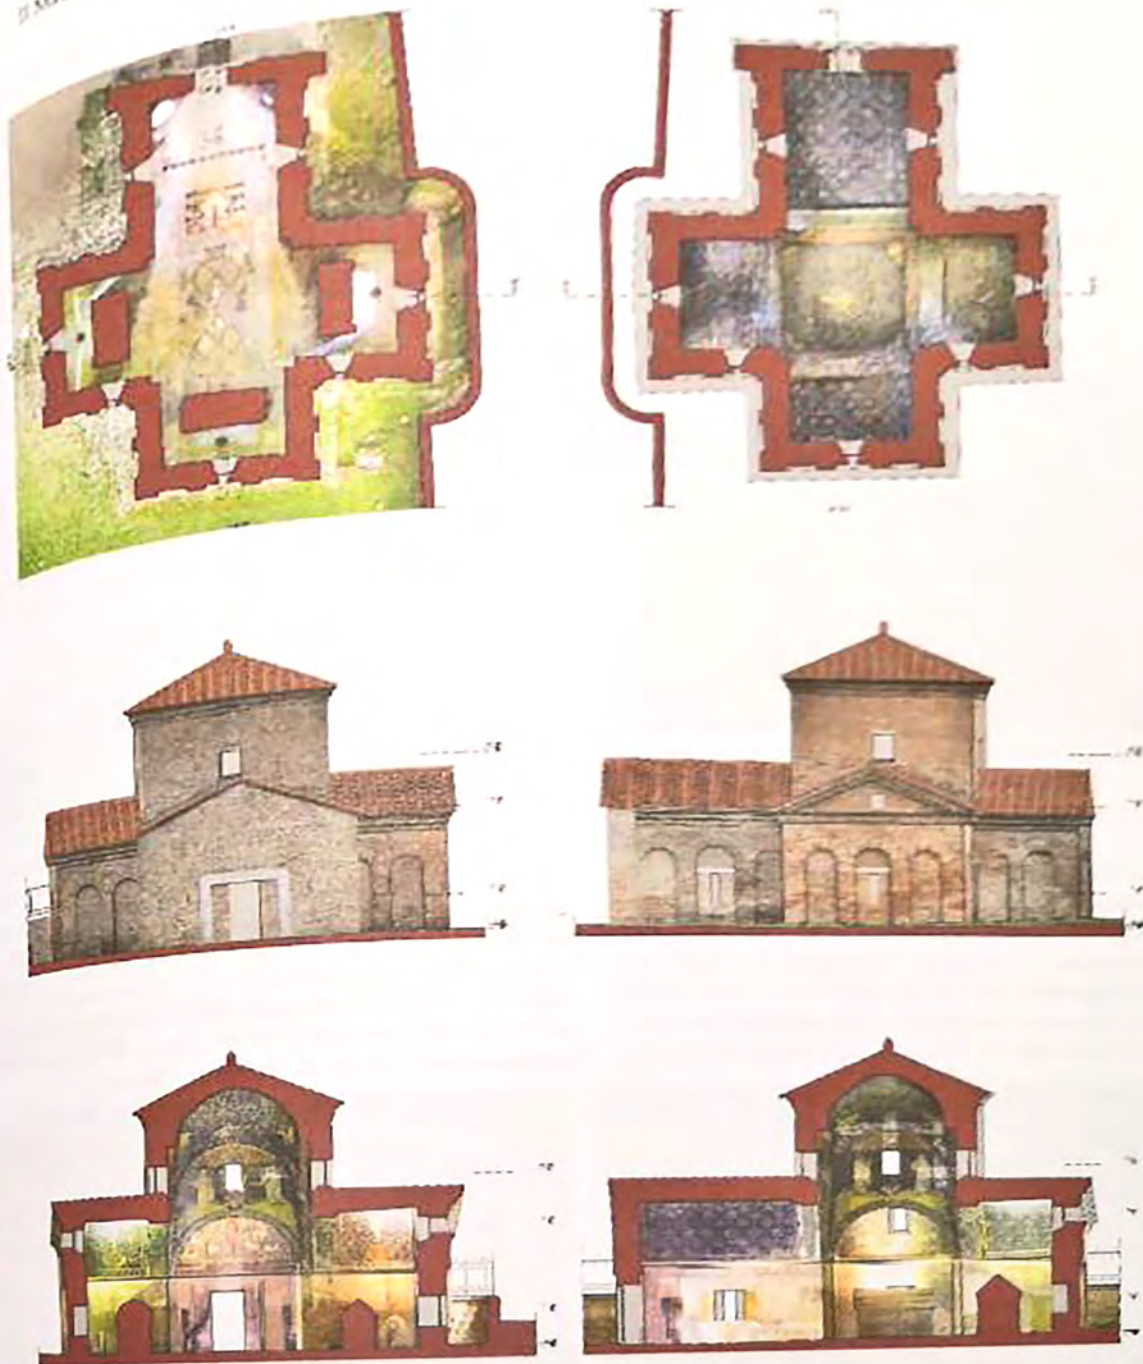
Pianta alla quota di +1.20 m; pianta delle volte (texture dalla fotogrammetria digitale M. Incerti); restituzione materica dei prospetti Nord e Ovest (texture dalla fotogrammetria digitale M. Incerti); restituzione materica delle sezioni AA' e BB' (texture dalla nuvola di punti M. Incerti) (restituzione complessiva G. Lavoratti).
